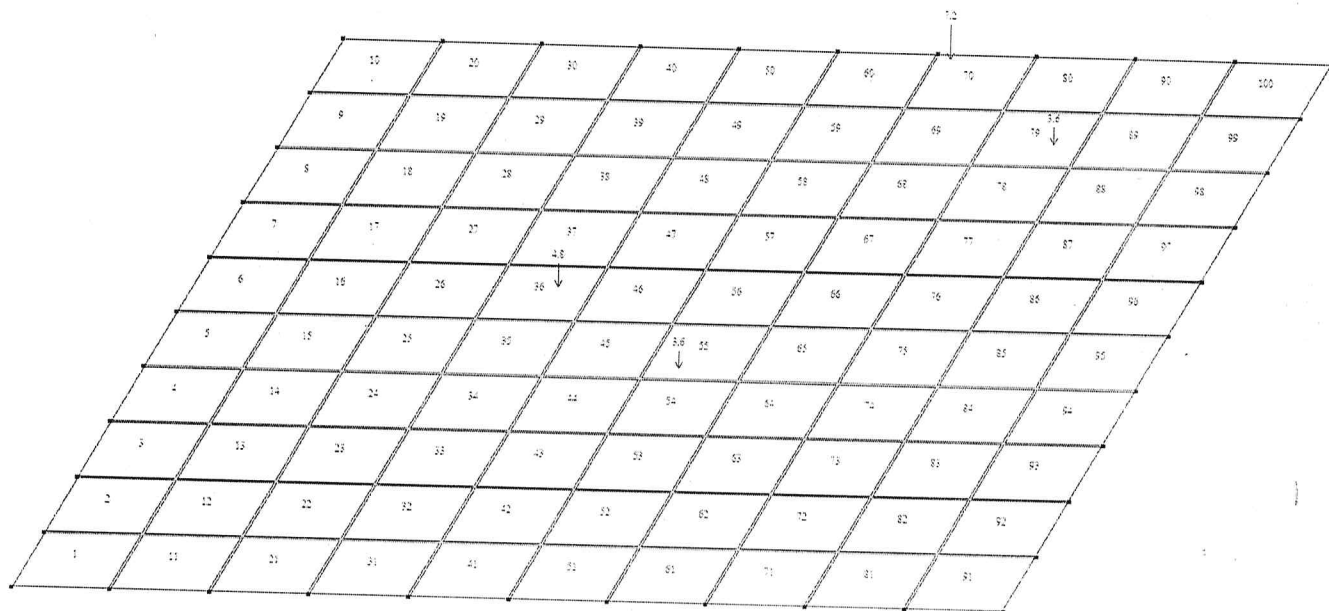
Нагрузки на плиту перекрытия шахты от лифтового оборудования
